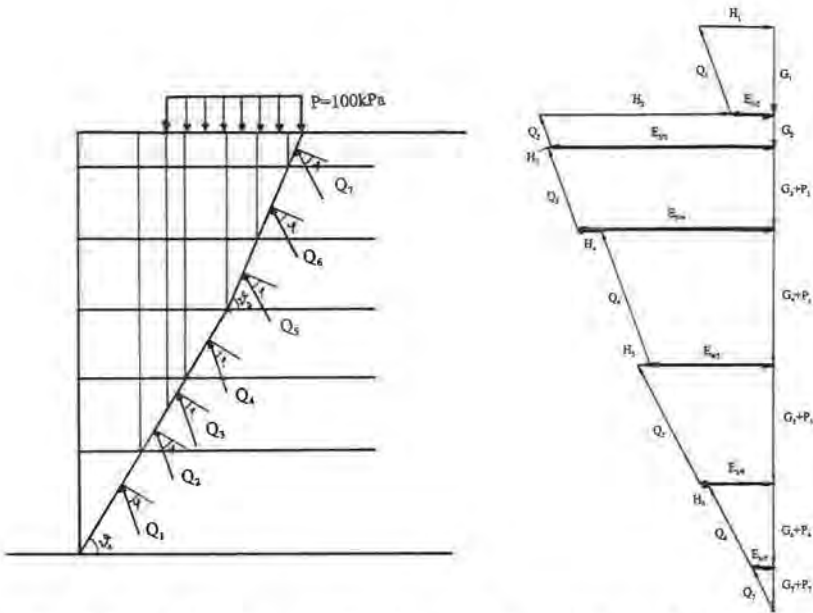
Wandgeometrie, Lamelleneinteilung und Kräfteplan für Beispiel 1 ($\delta=0$)
